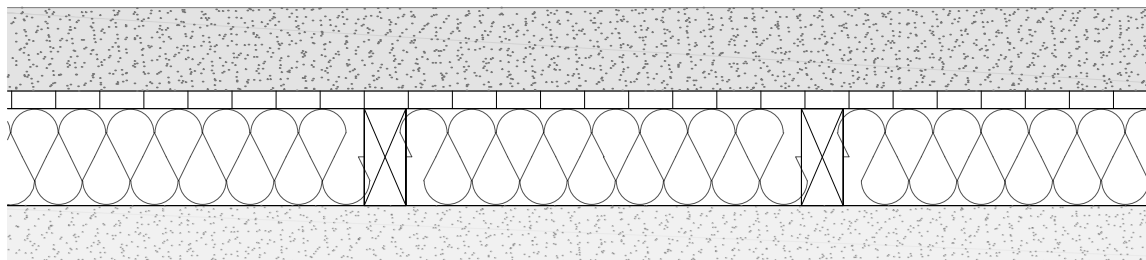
Grundaufbau des Holzlehmelementes. Leichtlehm, Holzkonstruktion mit Holzfaserdämmung, Vollholzschalung, Schwerlehm
